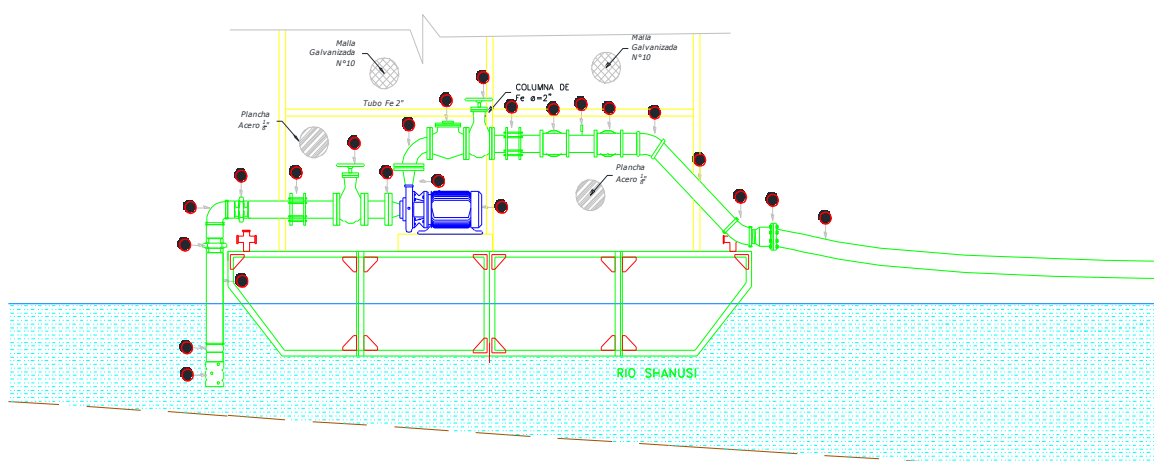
Vista de planta de la segunda parte del Pontón flotante.
